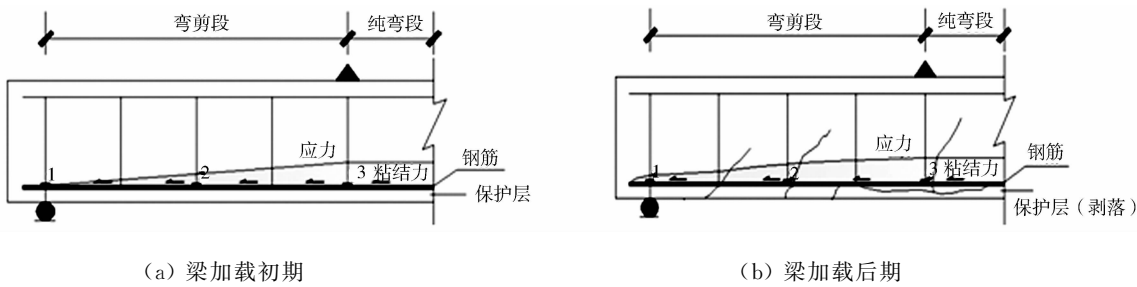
锈蚀钢筋混凝土梁加载过程应力传递图
